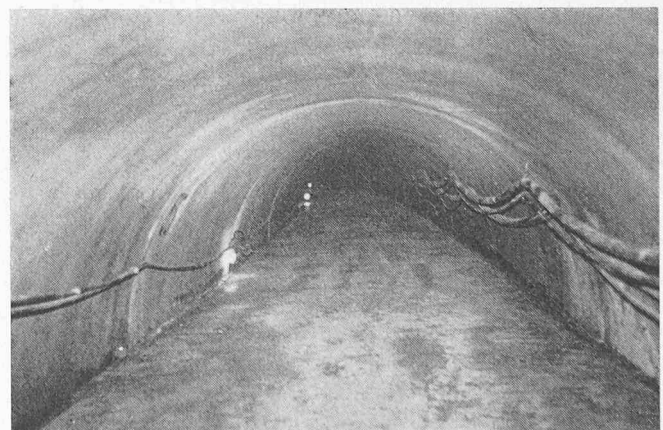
(links). Blick in einen der beiden Sohlstollen nach dem Einbau der Sonden für die Wasserhaltung
